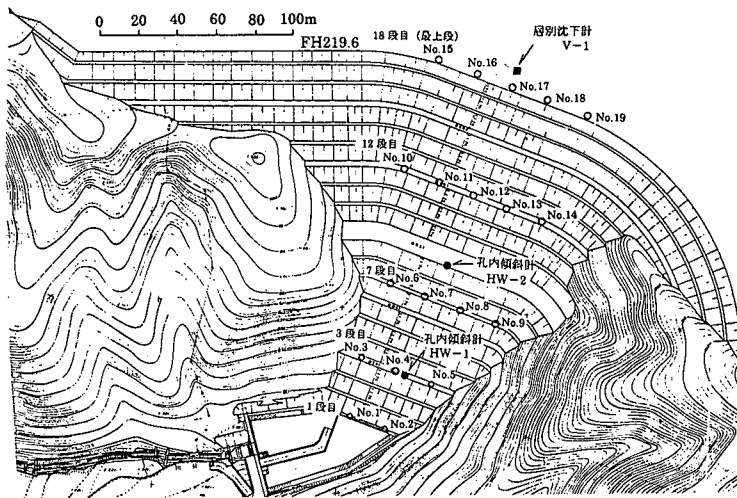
超高盛土部の平面図 (動態観測における測定位置も示す)
